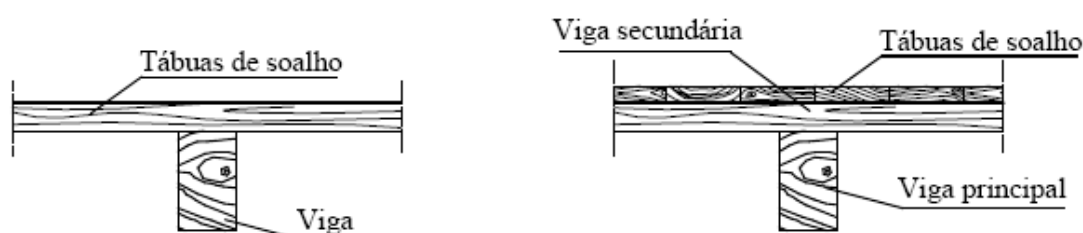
Sistema construtivo das lajes em madeira [Branco, 2002].
